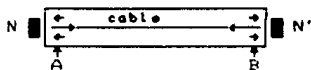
Viga de concreto con cable tendido en el eje neutro.
